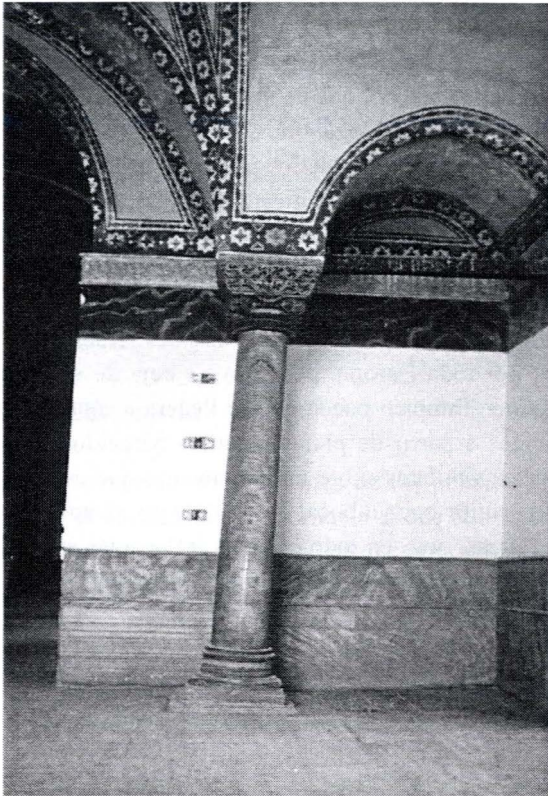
Columna muy inclinada de la galería del segundo piso. Santa Sofía. En la pared del fondo se ven los testigos de control de las grietas del muro
